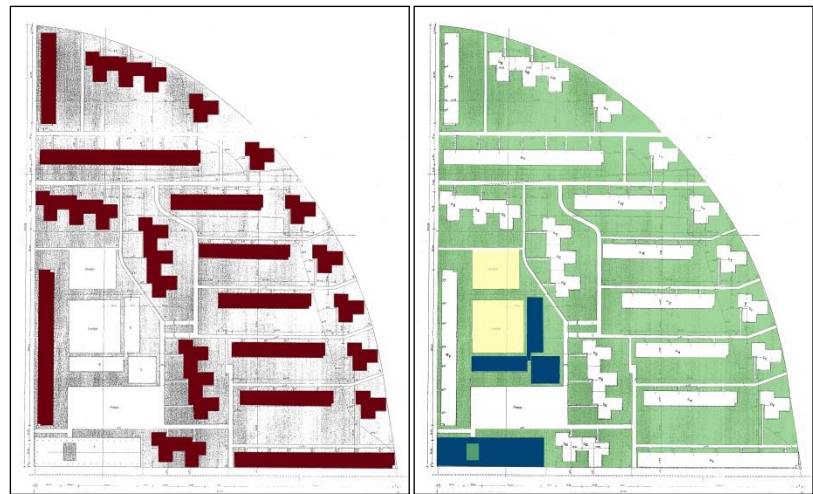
Grupo Virgen del Carmen. Izquierda: Planta de edificación. Derecha: Equipamientos y zonas verdes en el proyecto original. (Elaboración propia. Color sobre Plano de urbanización, saneamiento y alumbrado general, 1958).
